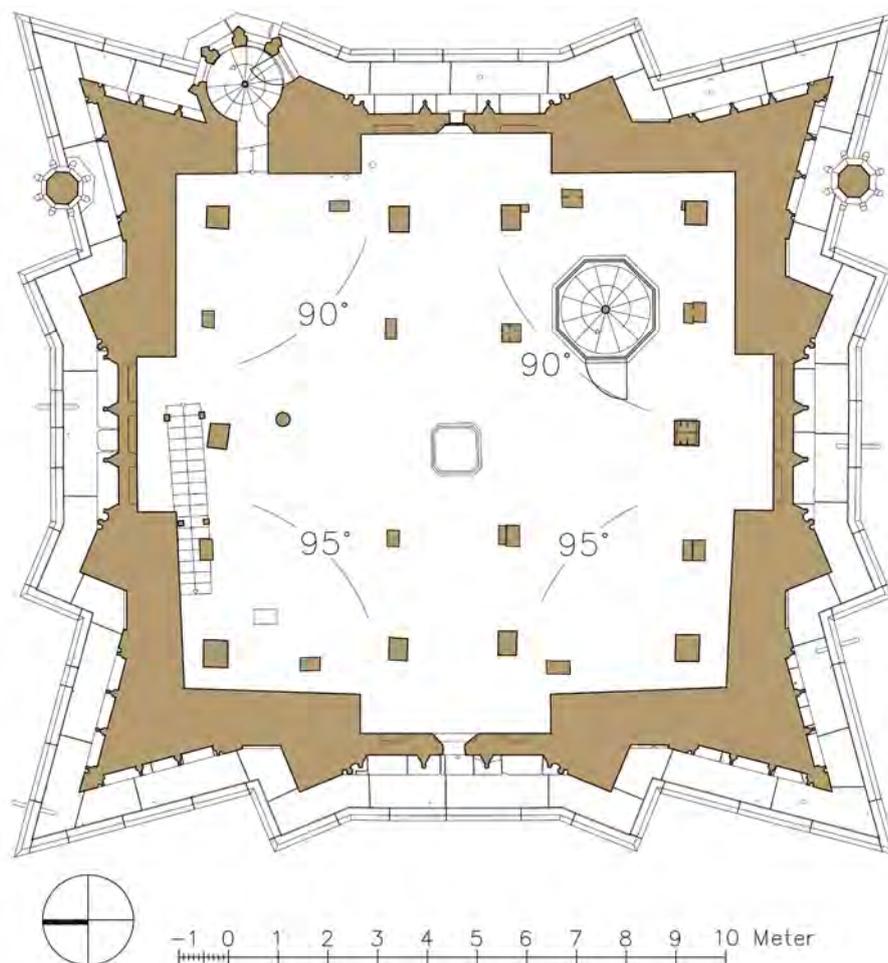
Grundriss auf der Höhe der Türmerstube mit eingetragenen Winkelmaßen der Innenecken
